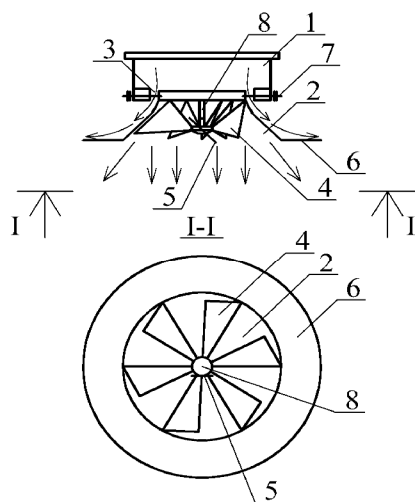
Схема закручуючого повітророзподільника: 1 – припливний патрубок; 2 – дифузор; 3 – кільцева регульована щілина; 4 – пластини; 5 – ручка керування; 6 – відбійний козирець; 7 – гвинт регулювання щілини; 8 – стрижень
